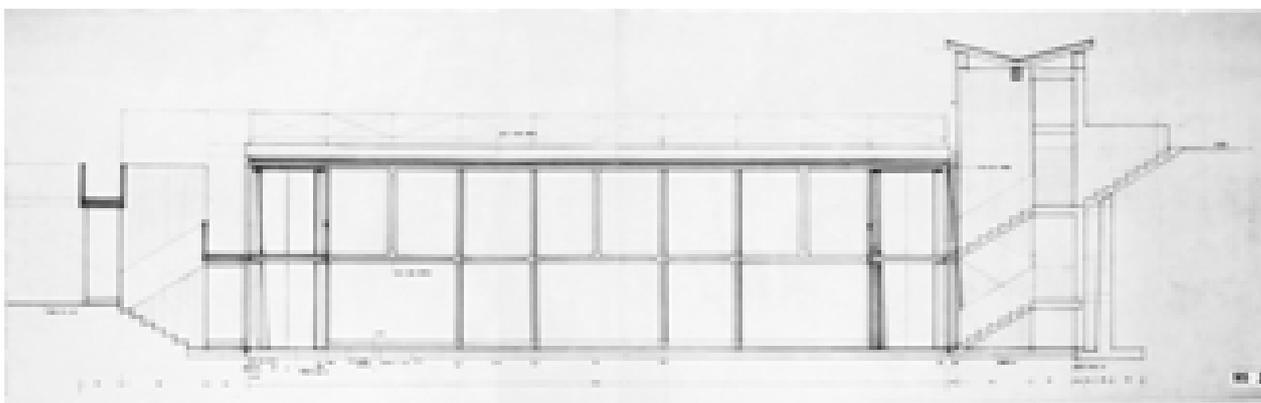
Sezione longitudinale prospetto esecutiva – stato futuro - s.d. (AABS-95.224)
